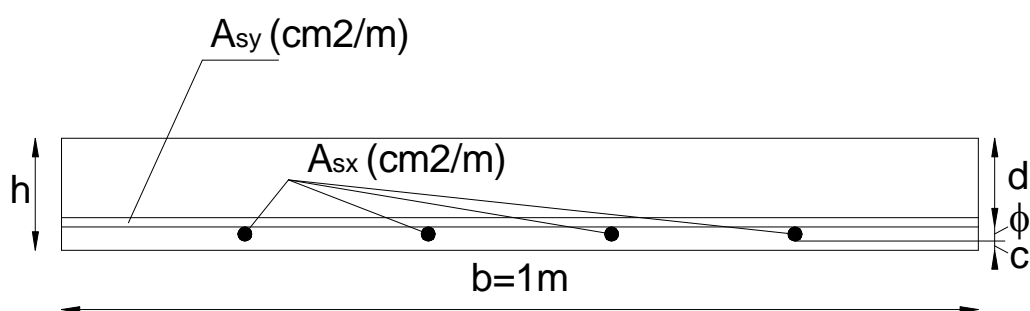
Seção Transversal para Cálculo das Armaduras.
